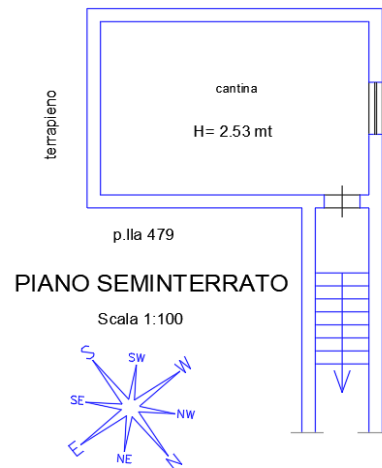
LOTTO 2 planimetria catastale piano interrato
